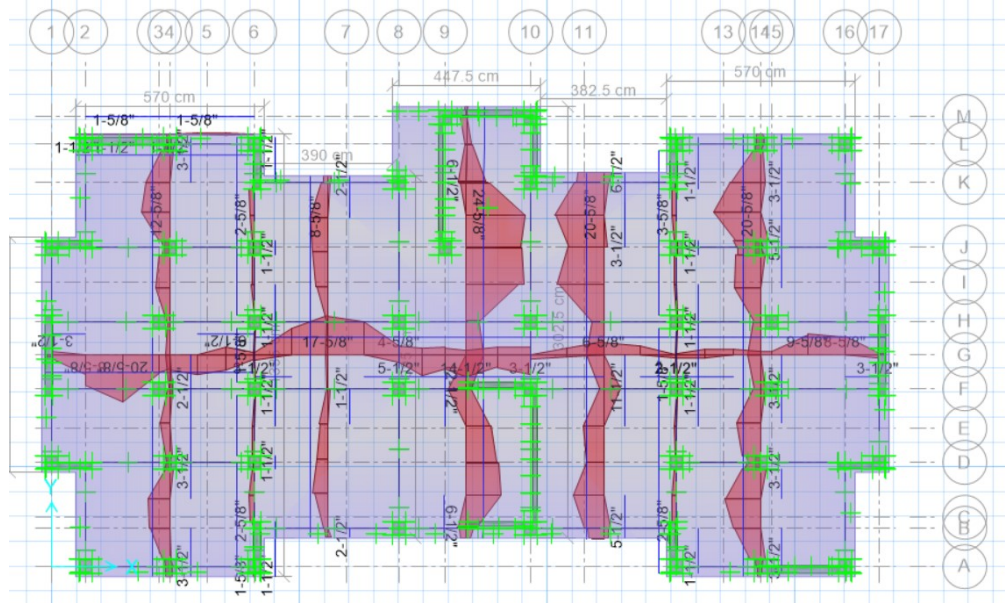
Distribución de acero en losa de cimentación Sistema Dual - Edificio Blesser. Fuente: Elaboración Propia.
